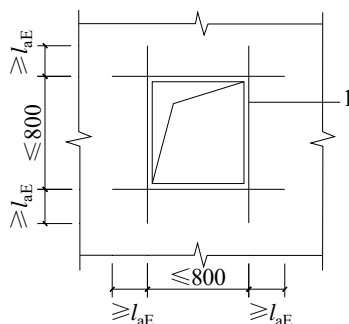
预制剪力墙洞口补强钢筋配置示意
